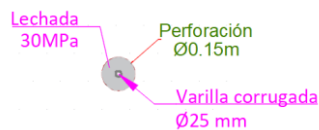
Detalle Bulón en sistema Muro-Estribo, vista frontal
